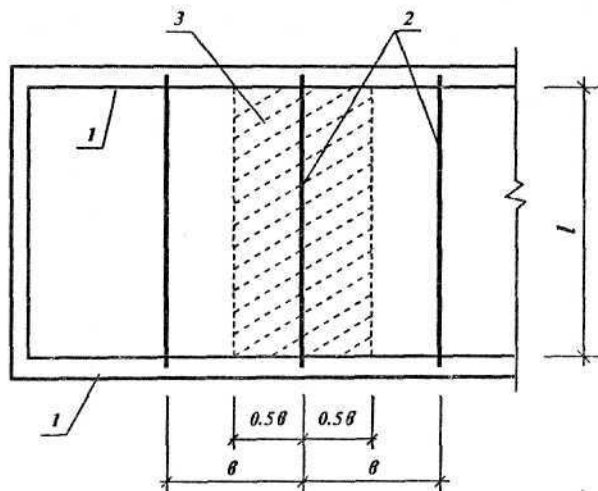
Схема сбора нагрузки на несущую опорную балку:
